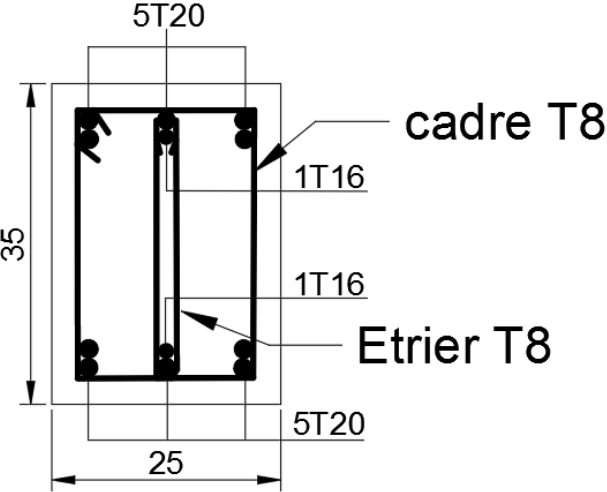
Ferrailage des poutres non porteuses sur appui
